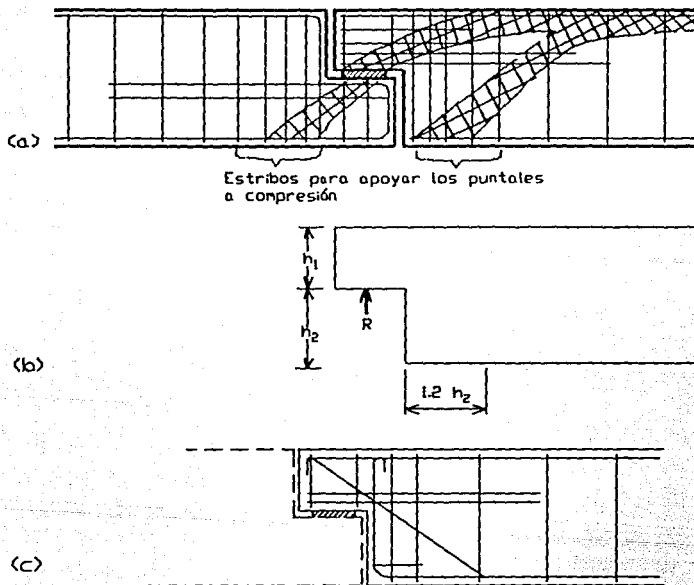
Los voladizos cortos forman una articulación en el claro de la viga. a) Utilizando refuerzo ortogonal. b) Utilizando varillas dobladas hacia arriba. (1.1)
